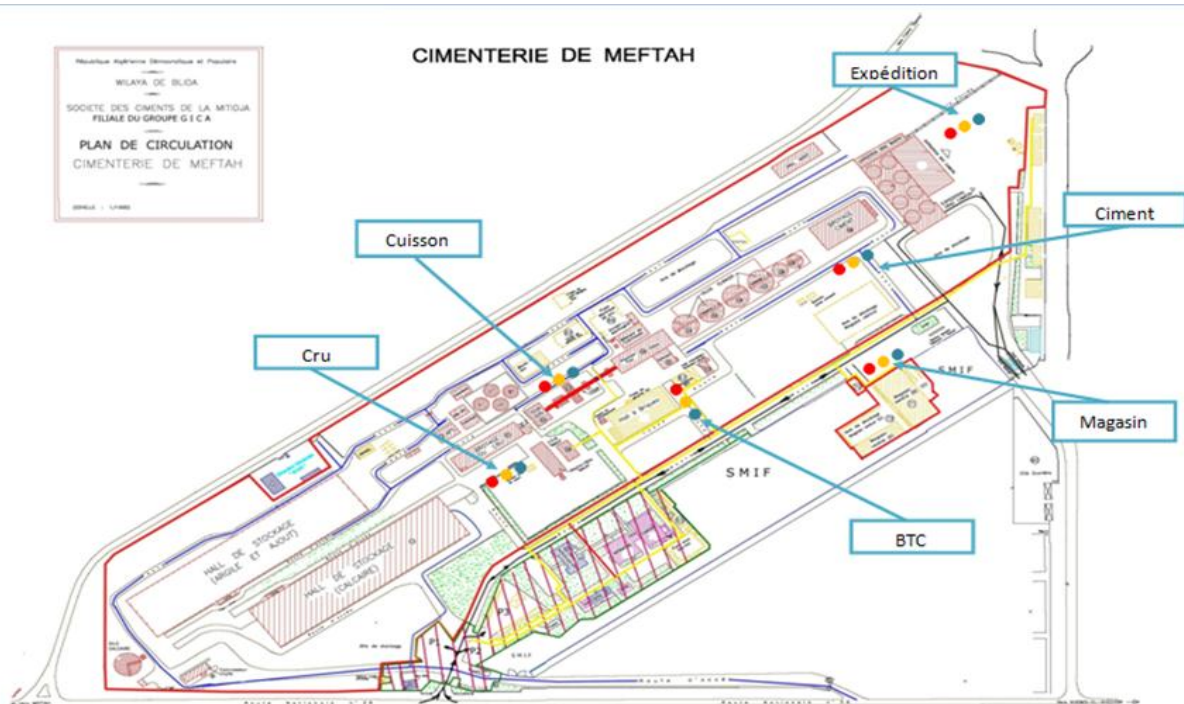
Plan de circulation de la cimenterie de Meftah [11]
